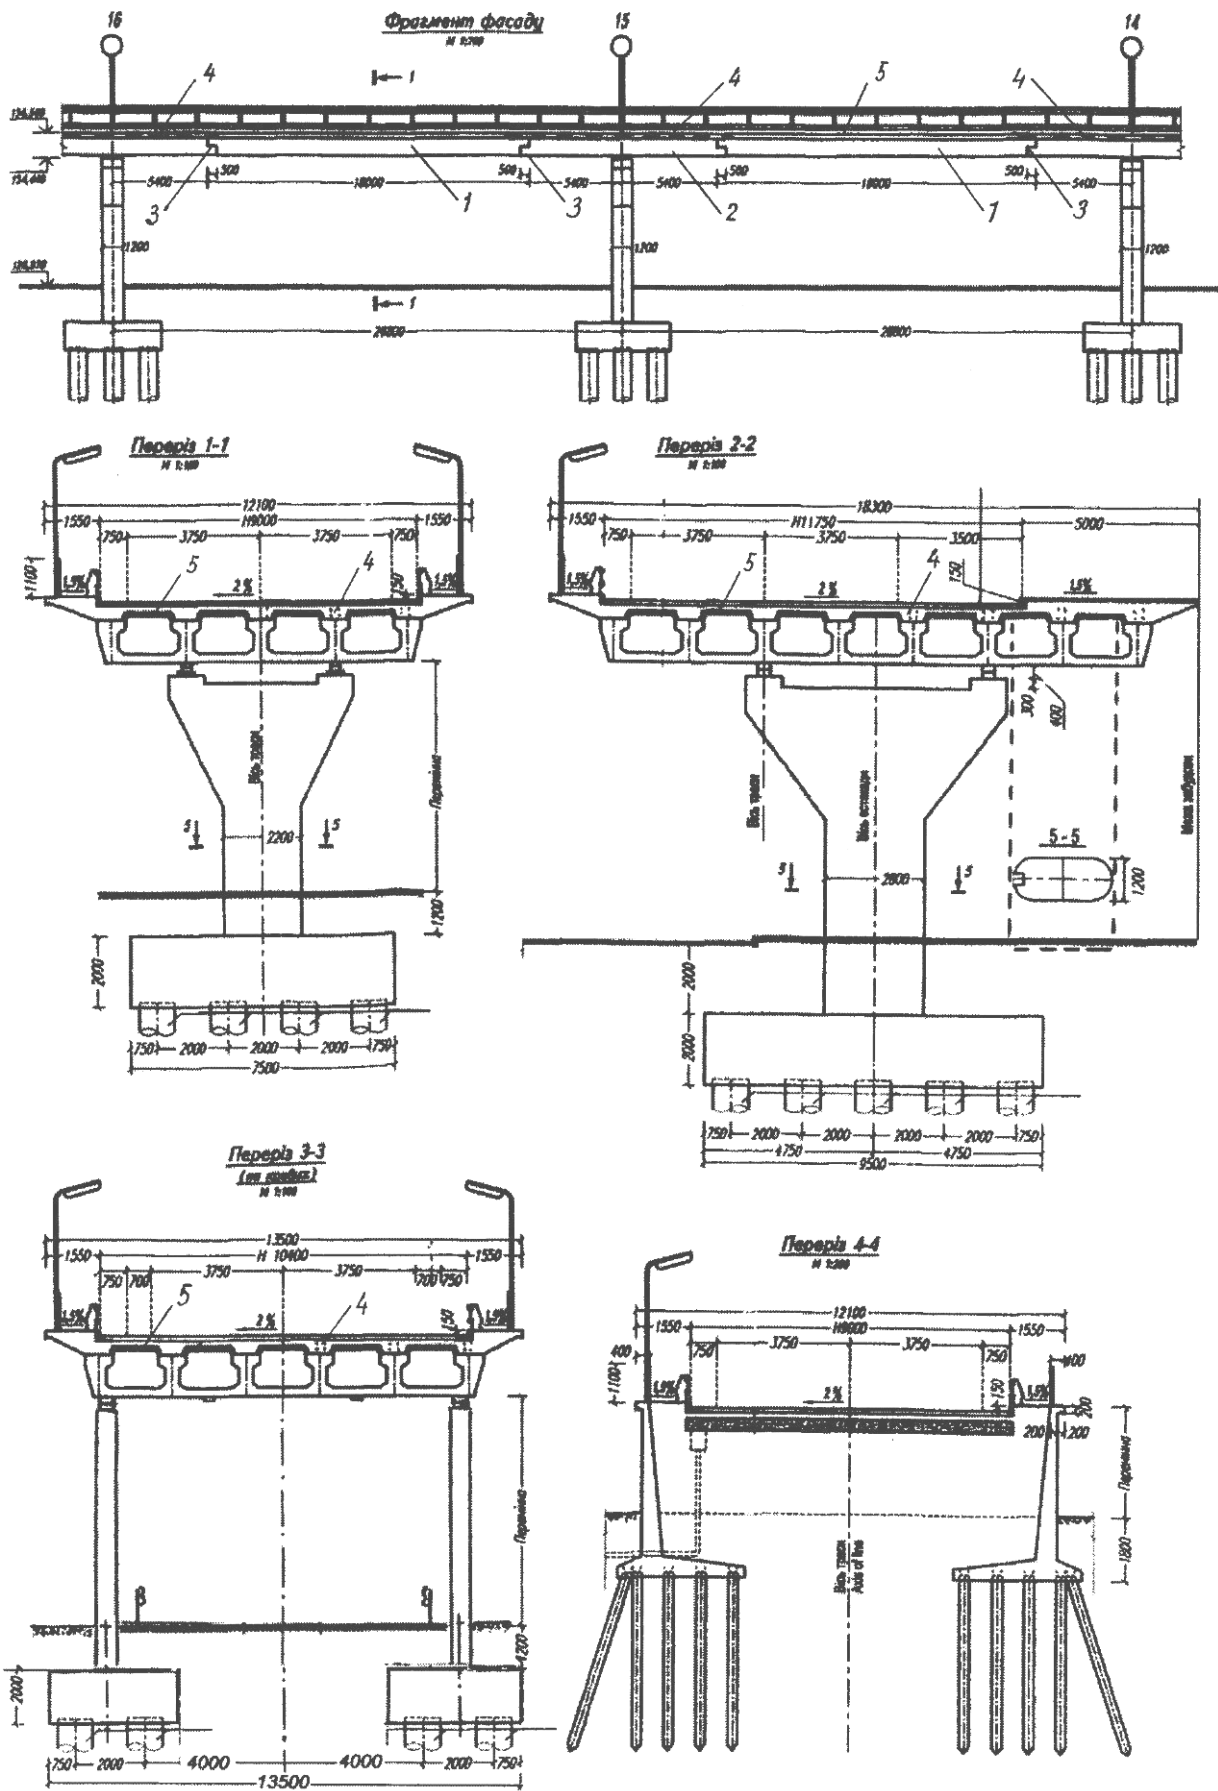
Фрагмент фасаду і поперечні перерізи проектованої естакади і пандусів
